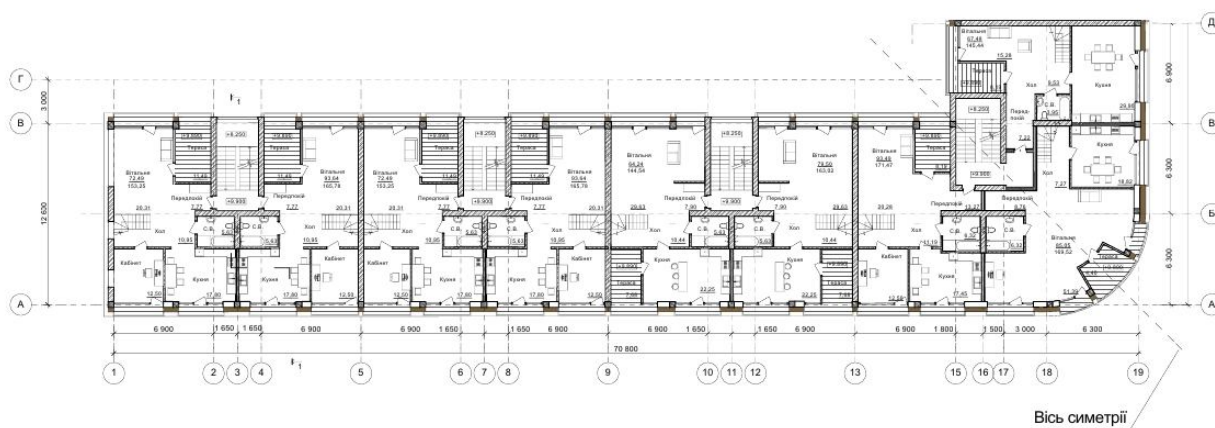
Приклади оформлення планів поверху житлового будинку
